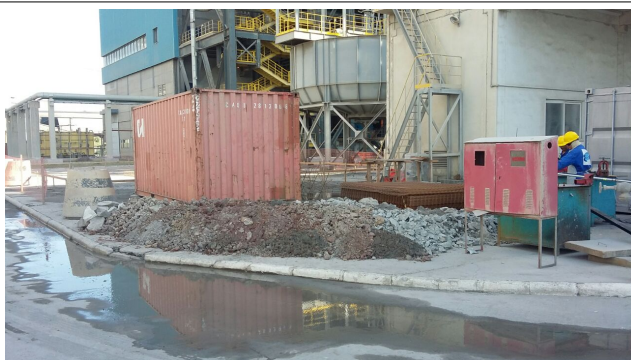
Instalação das caldeiras auxiliares da Fase C.
